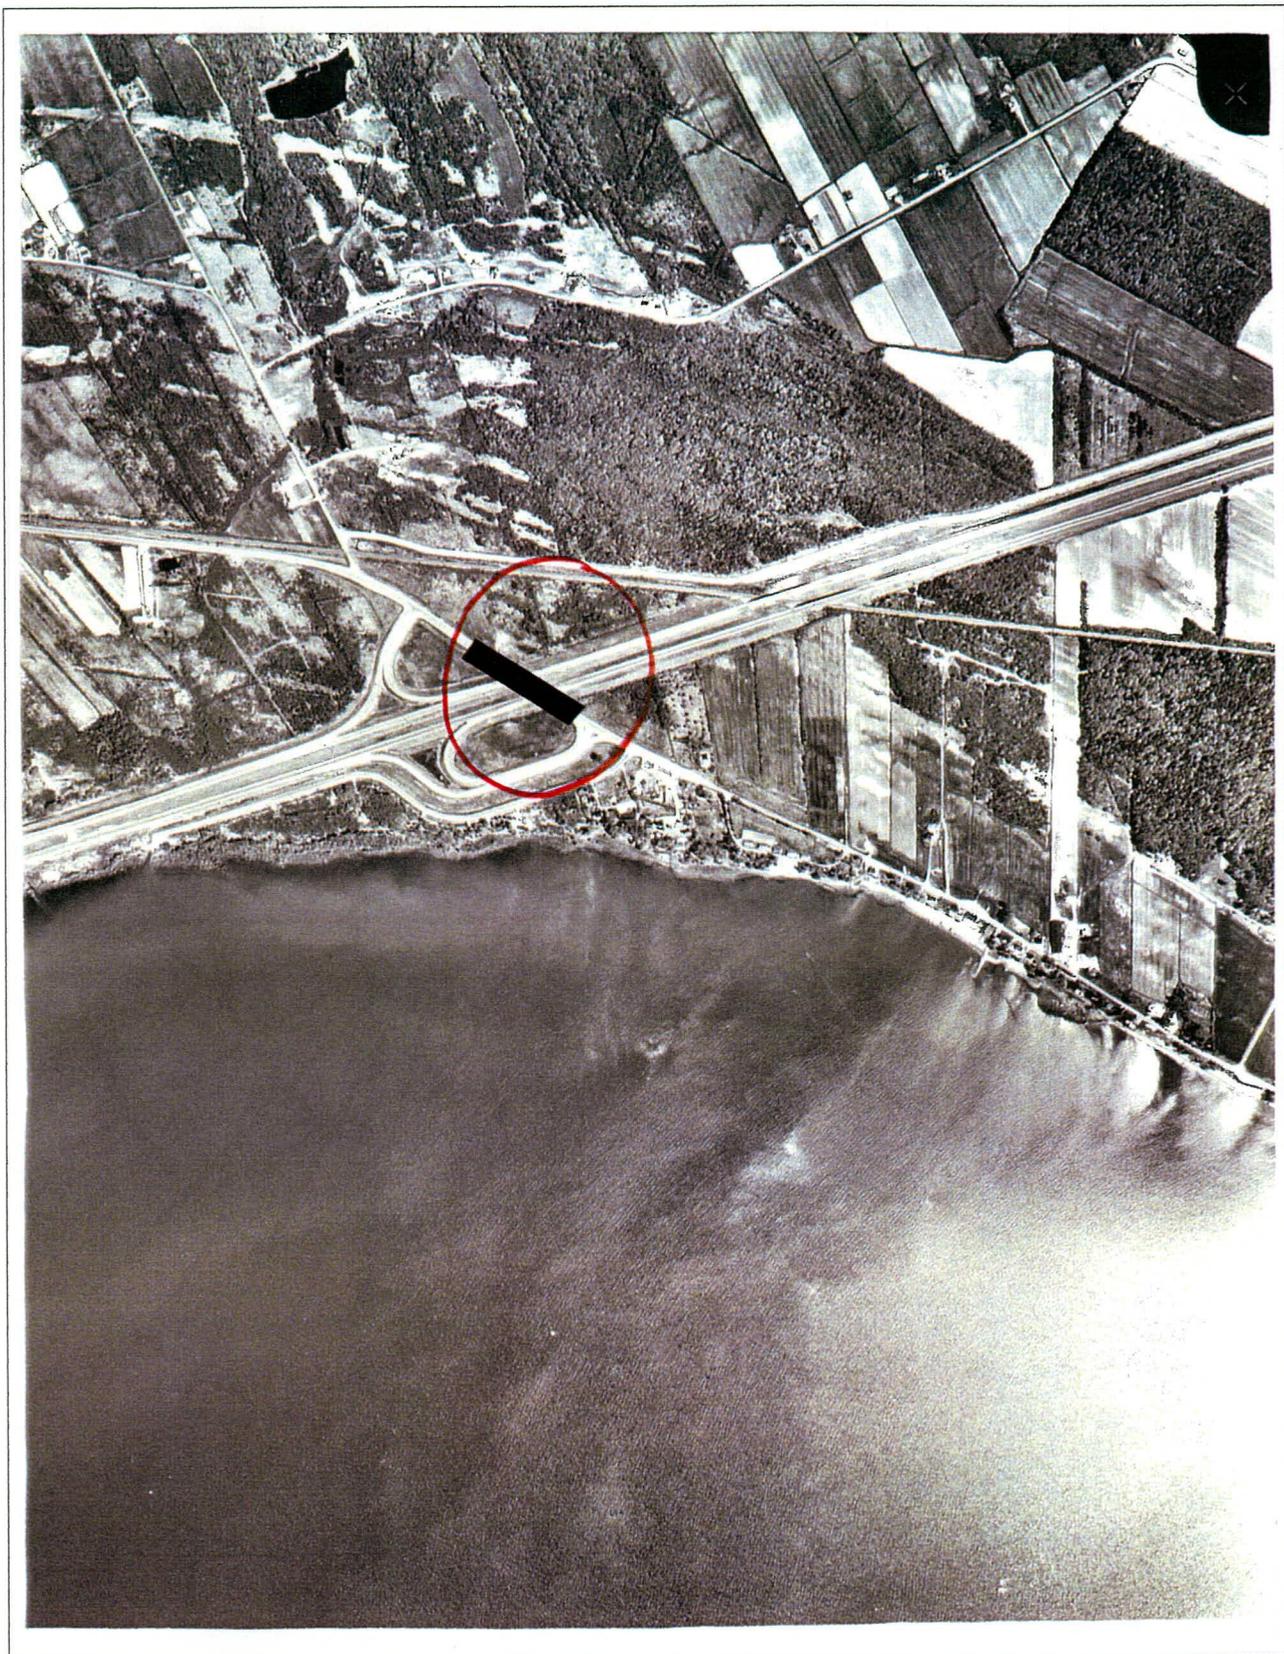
Localisation sur photo aérienne du projet 6373-9717, autoroute 40/route 138
